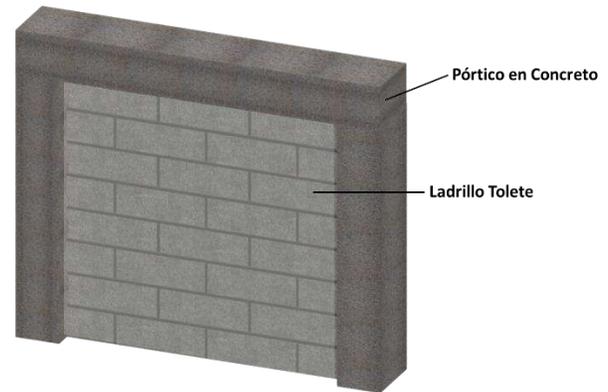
Detalle Mampostería Confinada Fuente: Elaboración Efren Ventura
